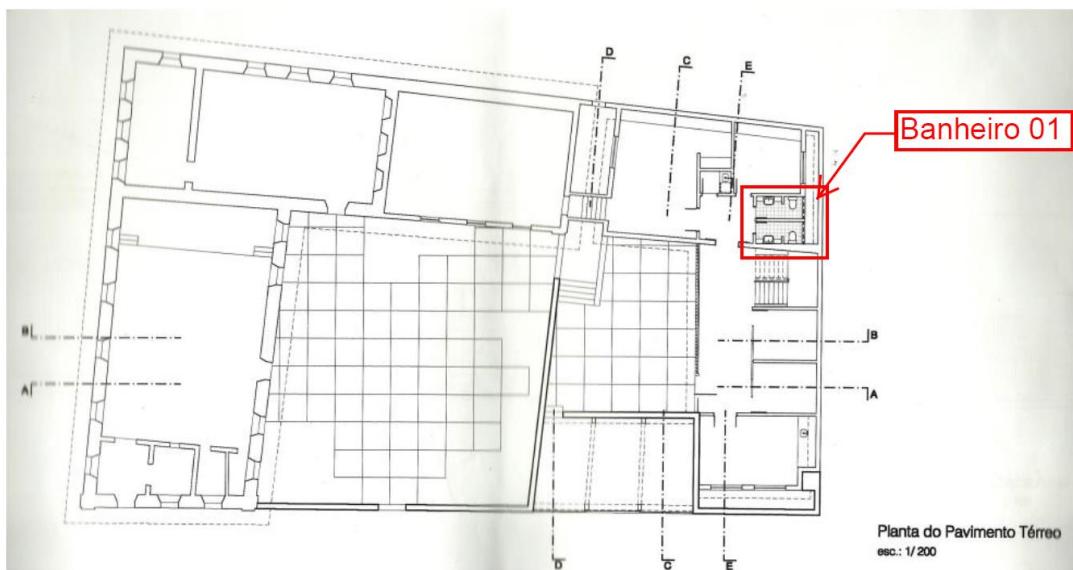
Planta Anexo II - Localização Banheiro 01 - Primeiro Piso
